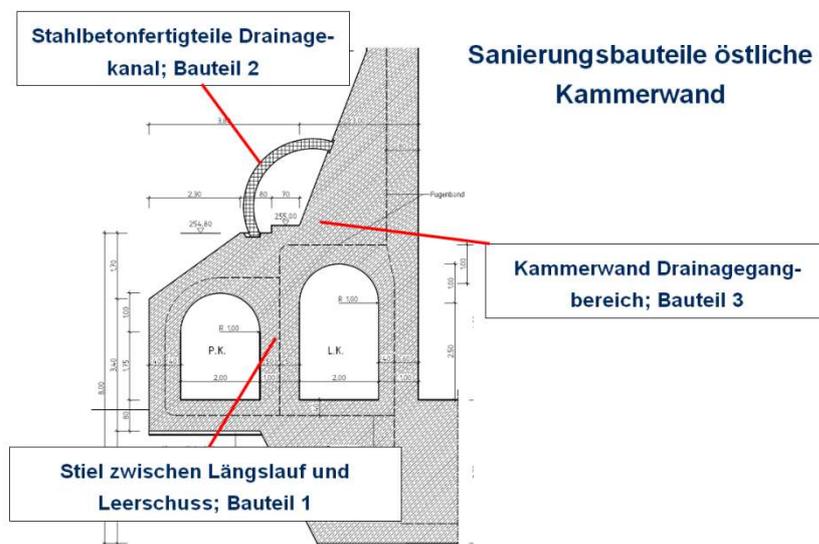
Bauteilbezeichnung Sanierungsbauteile östliche Kammerwand
